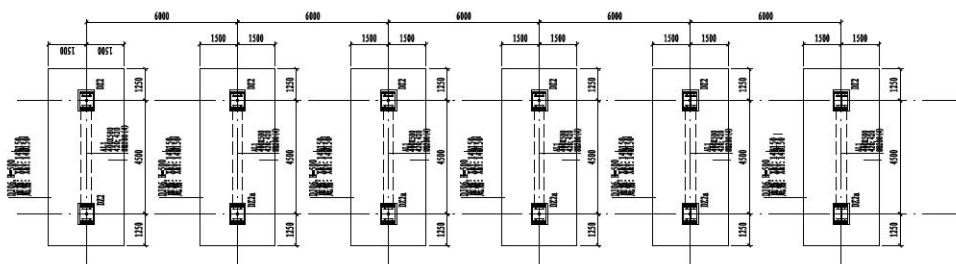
4m 宽钢筋混凝土管廊平面布置图
